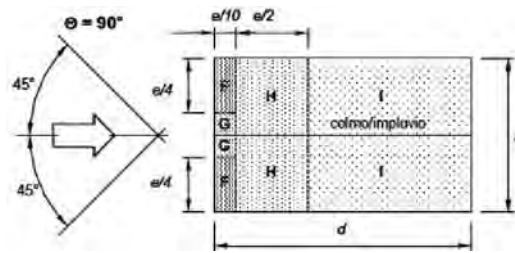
Suddivisione delle coperture a falda doppia in zone di uguale pressione
